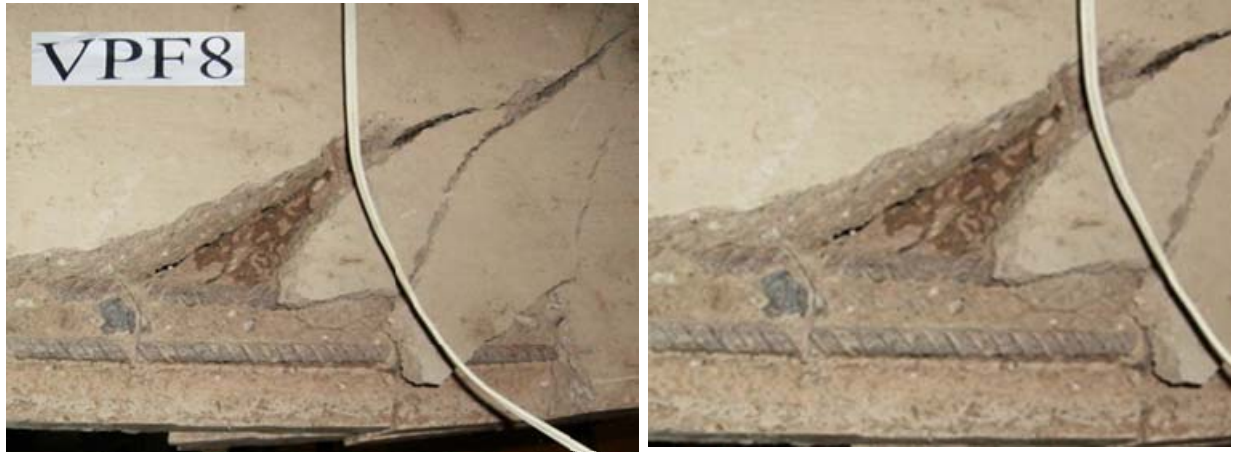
Detalhes das camadas de concreto fissuradas nas mesmas seções VPF8
